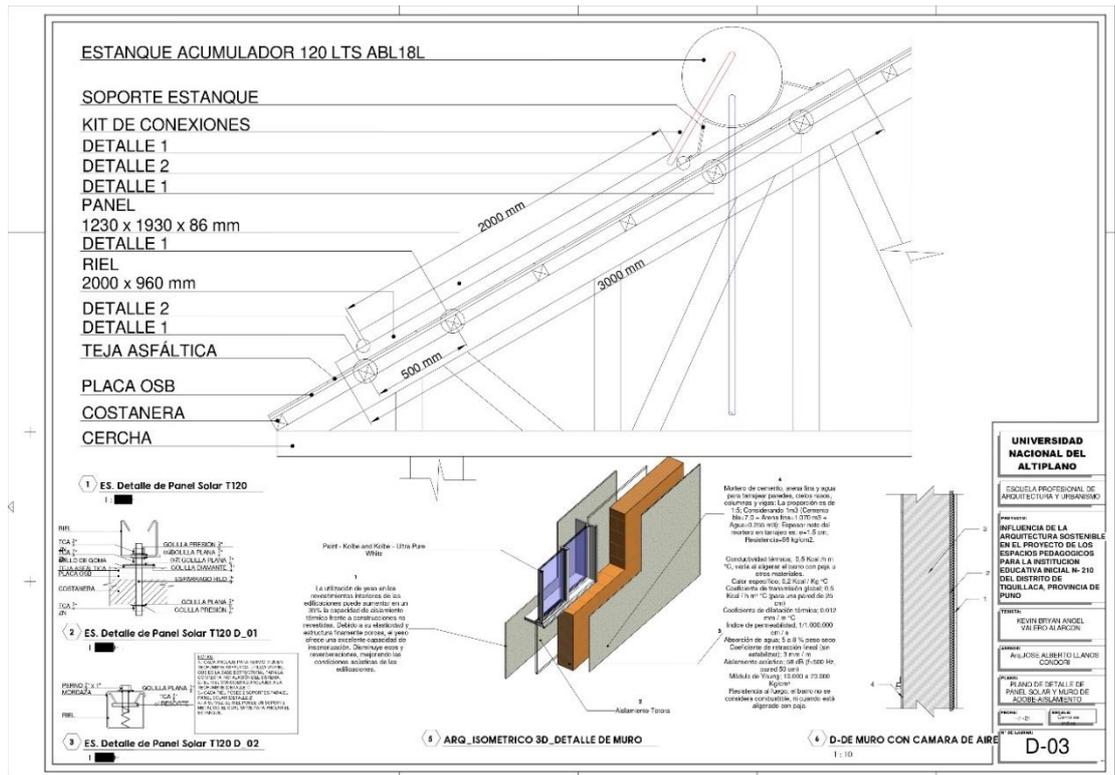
Plano D-03 de detalle de panel solar y muro de adobe aislamiento
